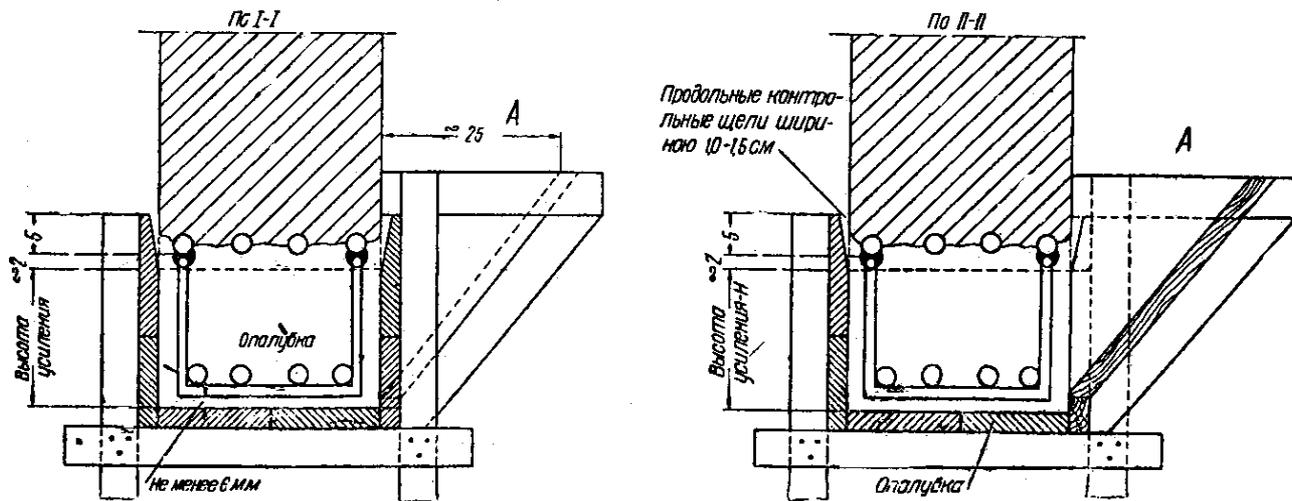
Рекомендуемый тип опалубки для усиления балок по нижней грани:
